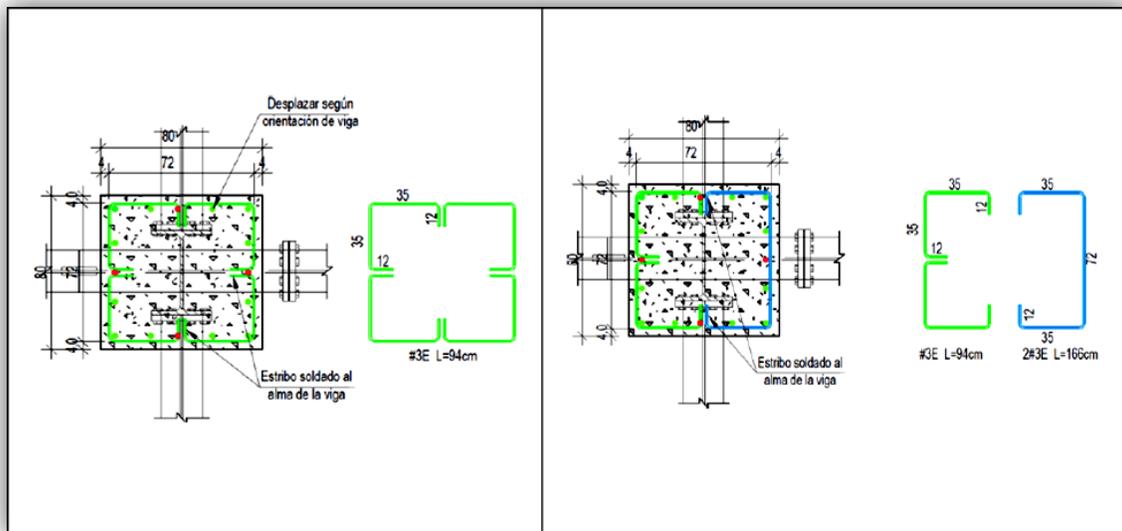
Refuerzo transversal de las columnas de 0.80 m x 0.80 m en los nudos.
